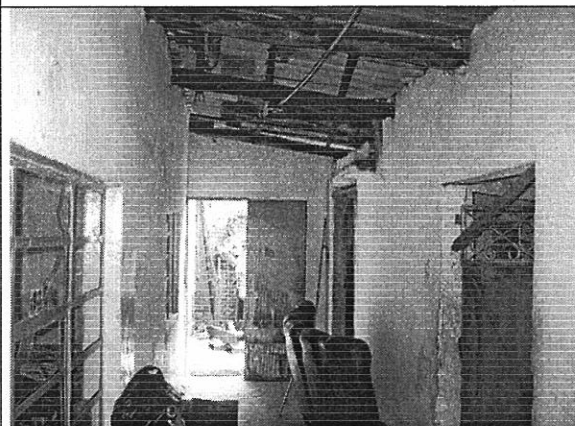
Aspecto interno del sector medio, fisuras en muros
